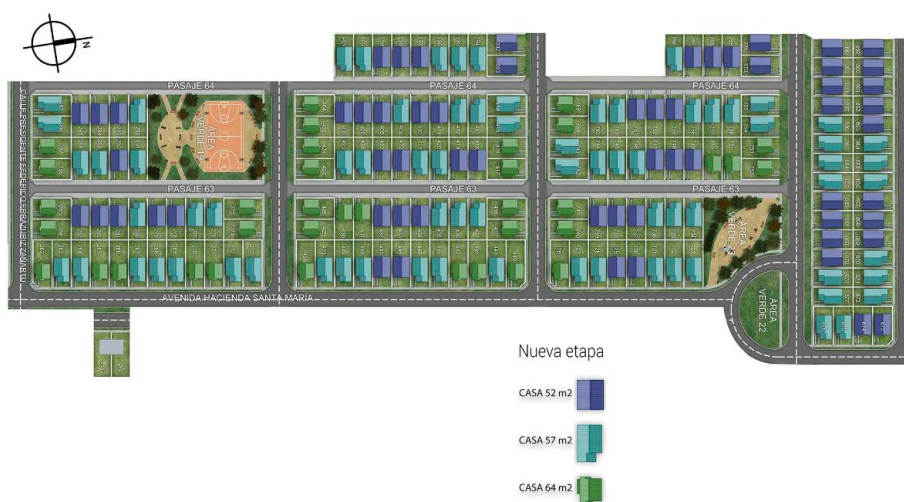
Plan maestro Hacienda Santa María de Labranza, SOCOVESA
